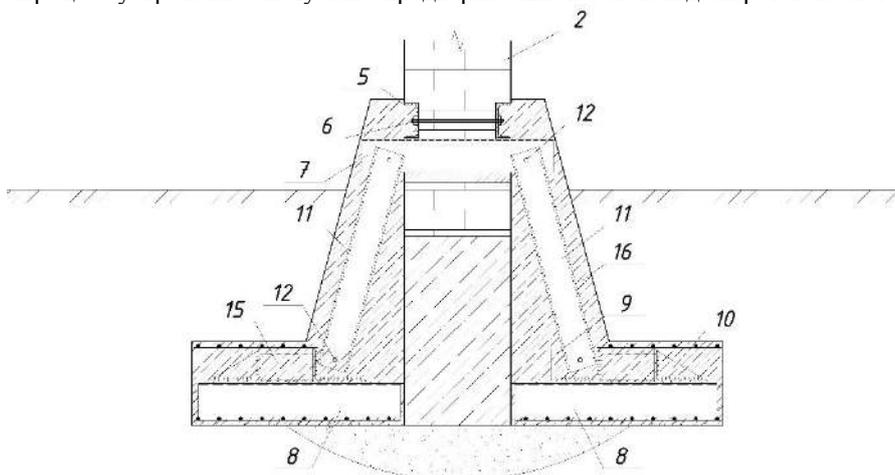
Готовый к эксплуатации усиленный ленточный фундамент несущей стены с устроенной железобетонной обоймой
